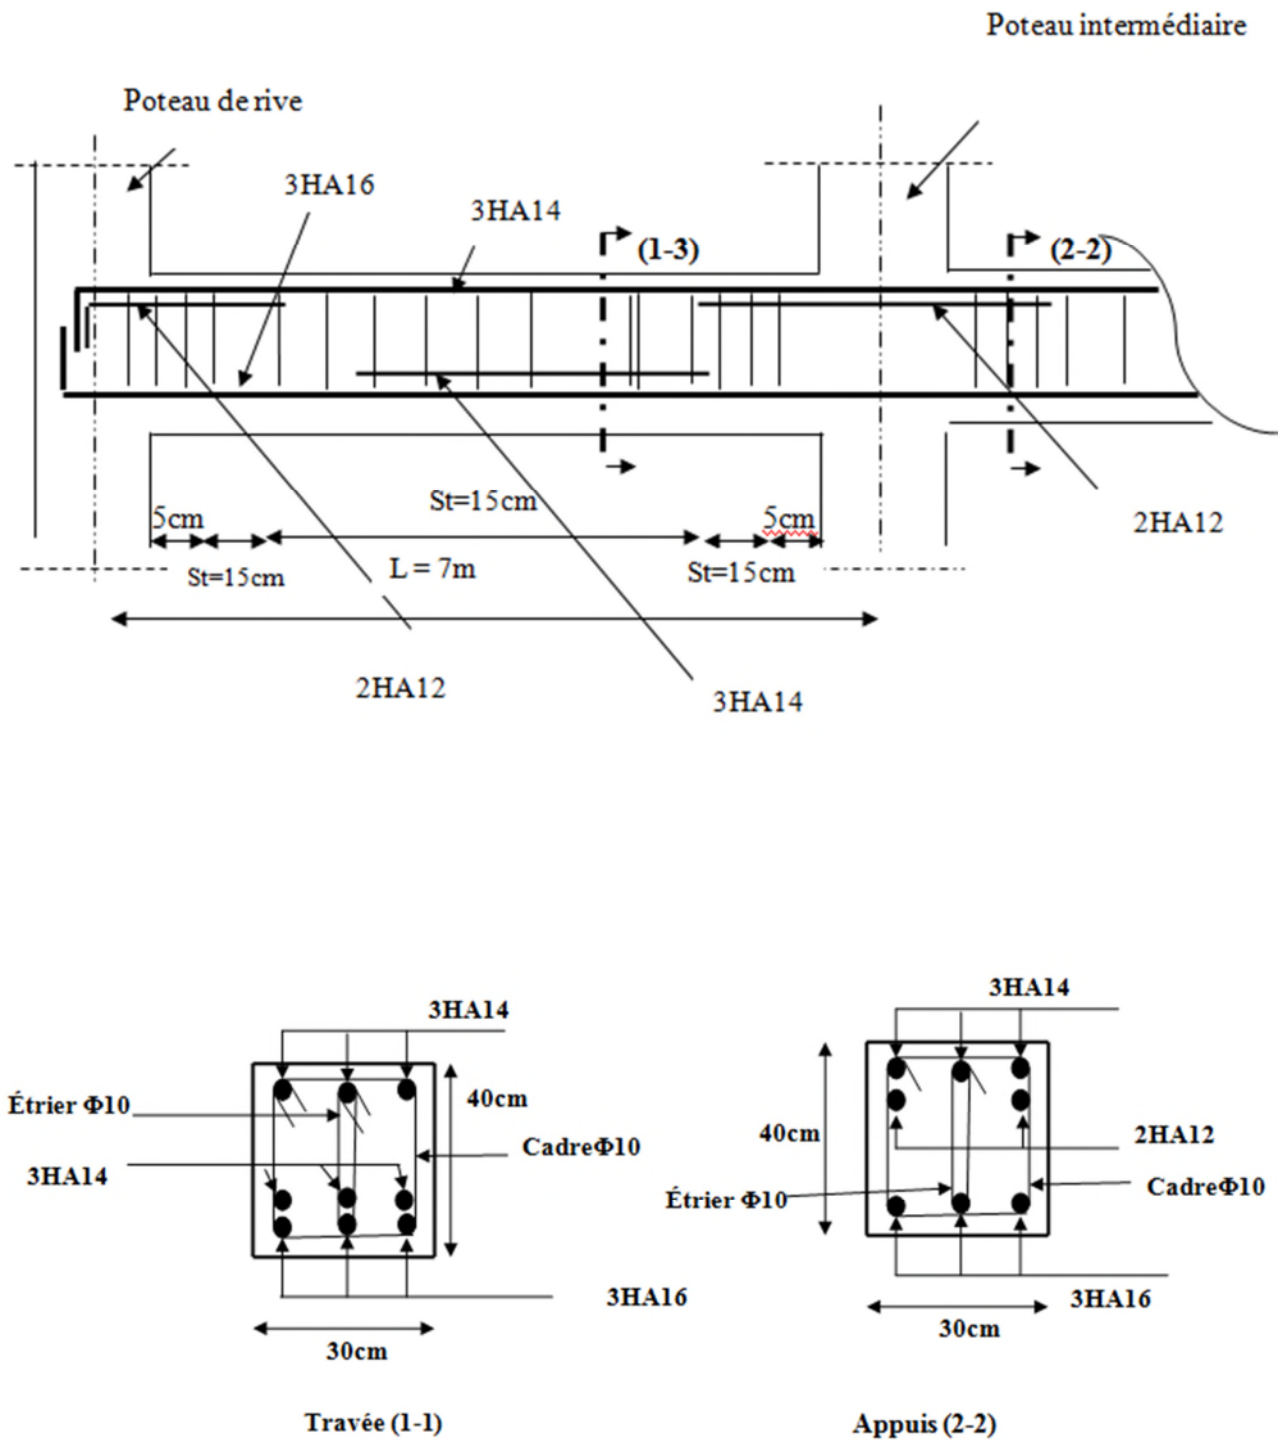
Schéma de ferrailage de la poutre secondaire (30*40) du sous sol RDC et 1^{er} étage
